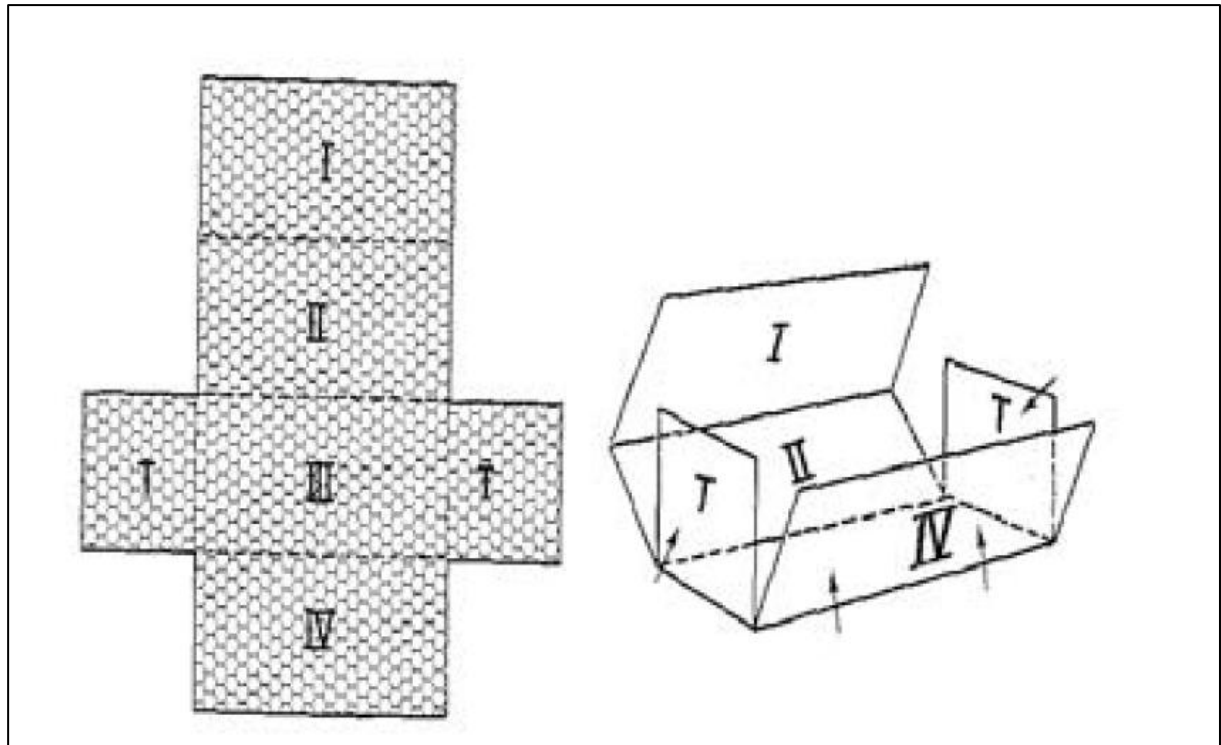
plan de construction des seuils en gabions (Roy, 2007)
